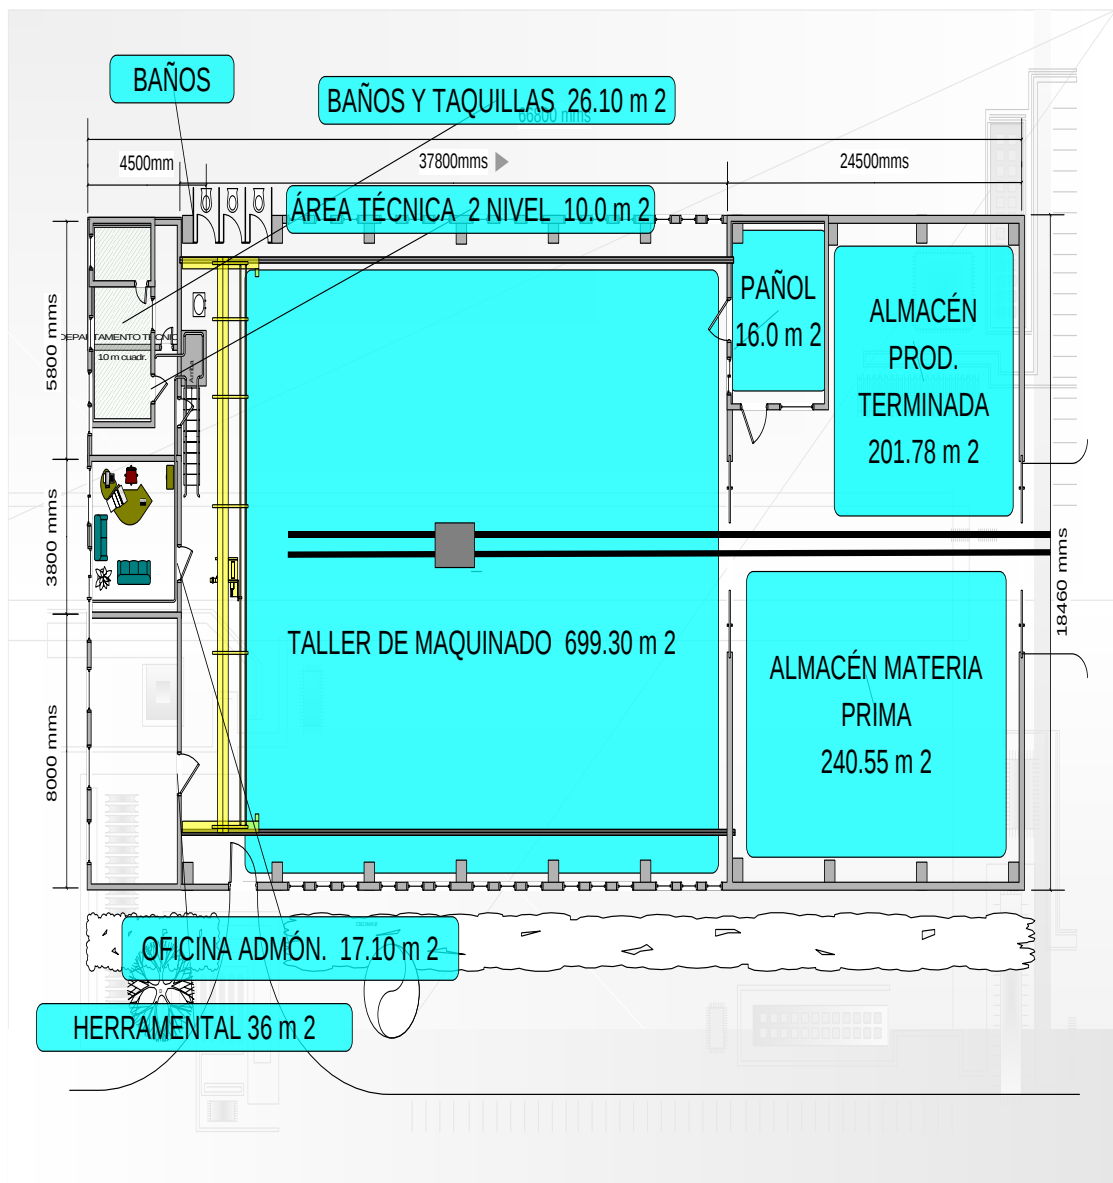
Distribución actual de la planta .Fuente: Elaboración propia.
